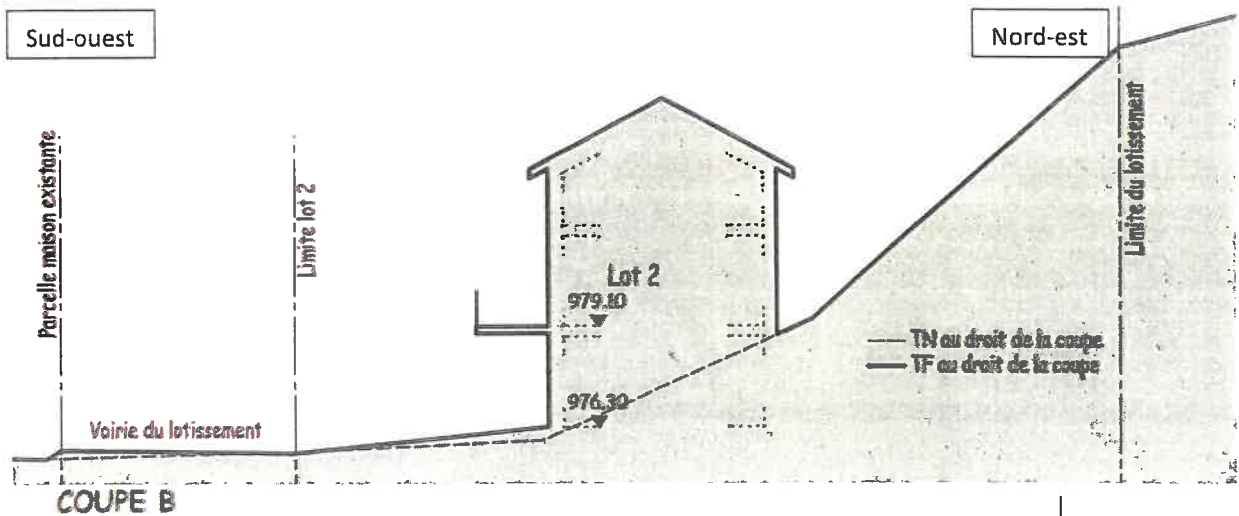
Vue en coupe du projet sur le lot n°2 (SARL Paillard Archi & Co)
